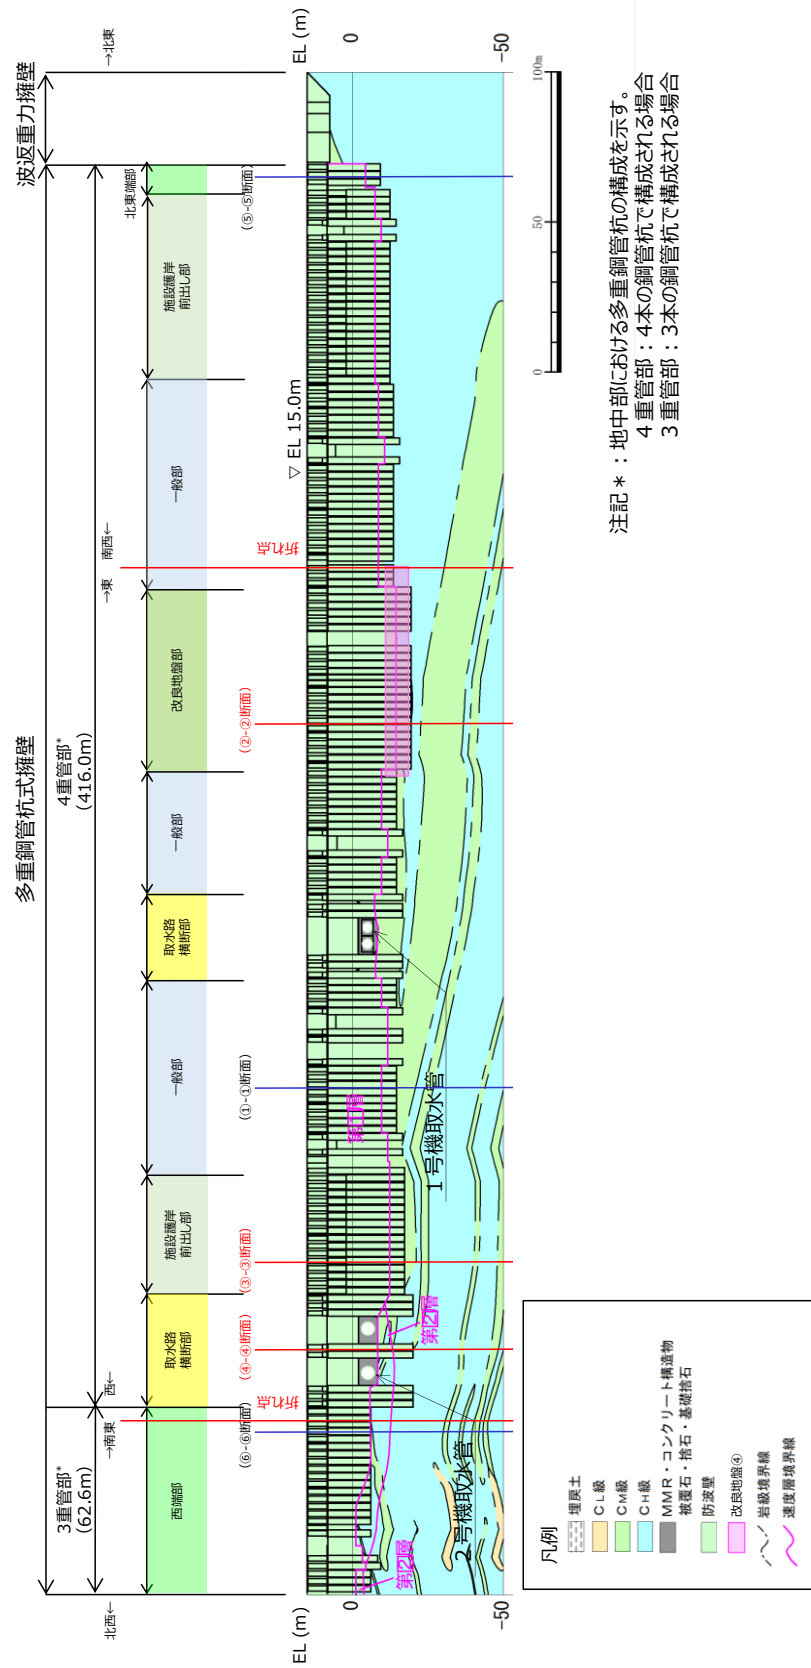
防波壁（多重鋼管杭式擁壁）の縦断面図
